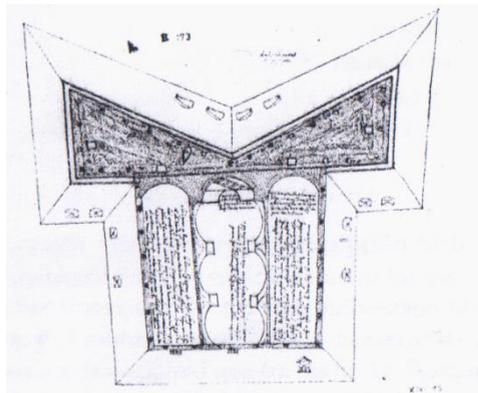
plan du bordj Moussa à l'époque espagnole (Epalza, 1988)
